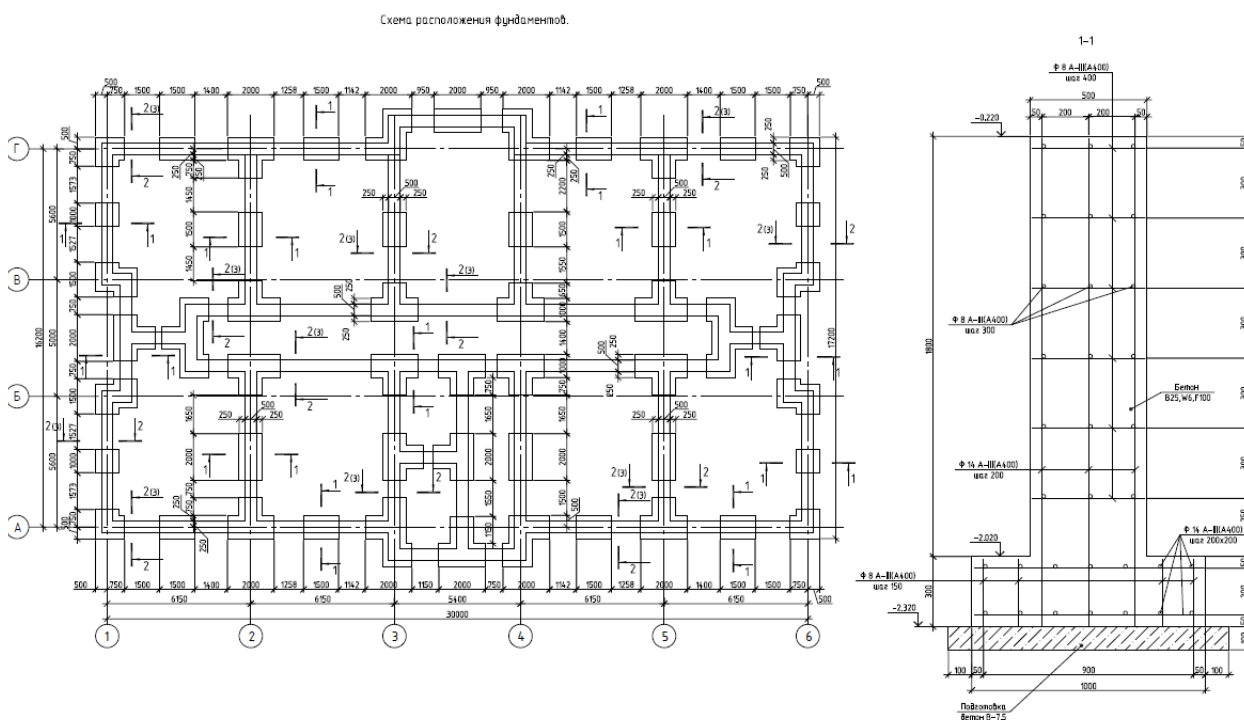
Схема расположения фундаментов. Сечение 1-1 по фундаменту
